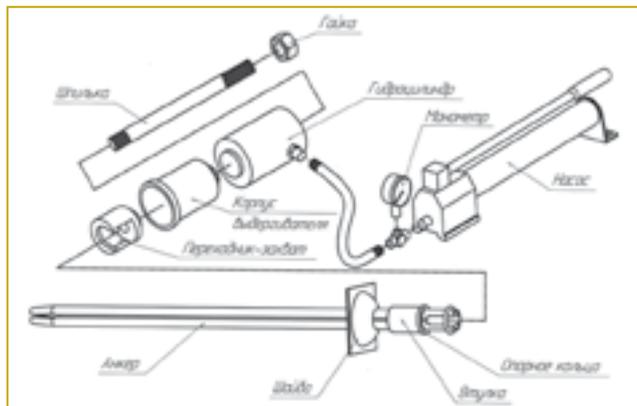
Схема соединения прибора контроля анкерной крепи и размещение дополнительных устройств на анкере для проведения испытаний
